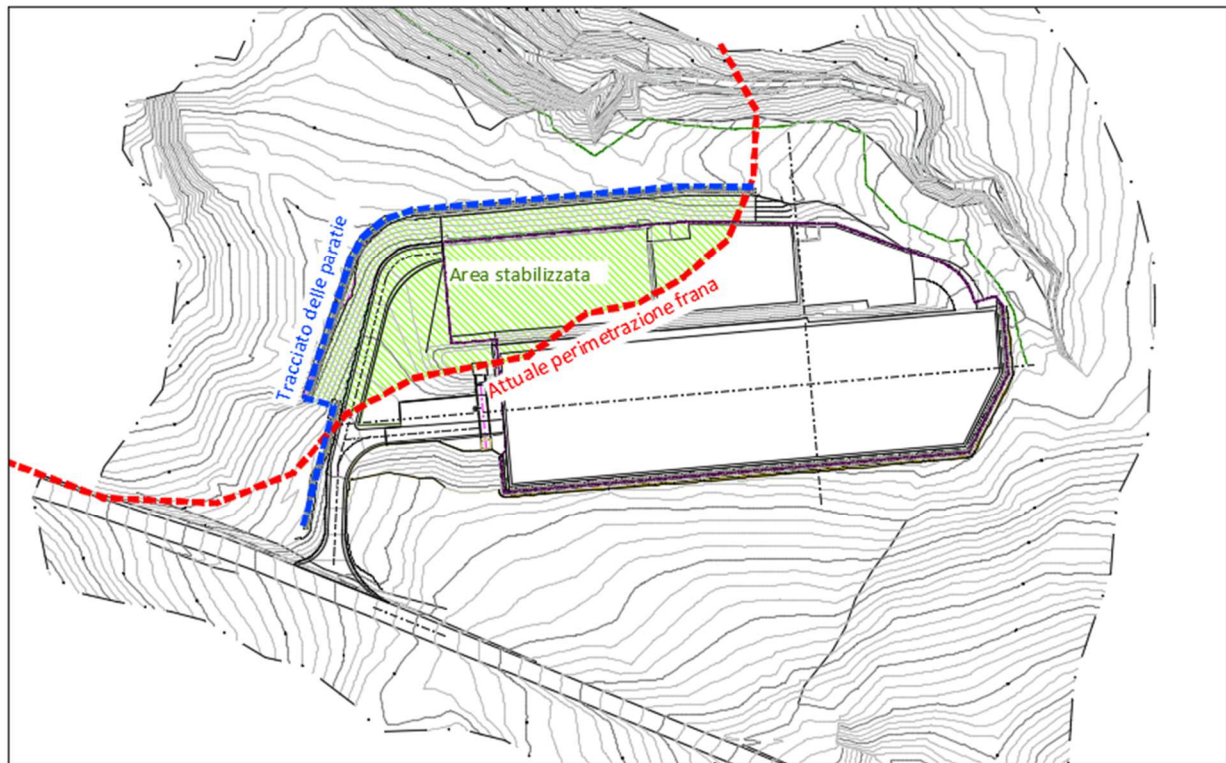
Area stabilizzata dalle opere di consolidamento.
